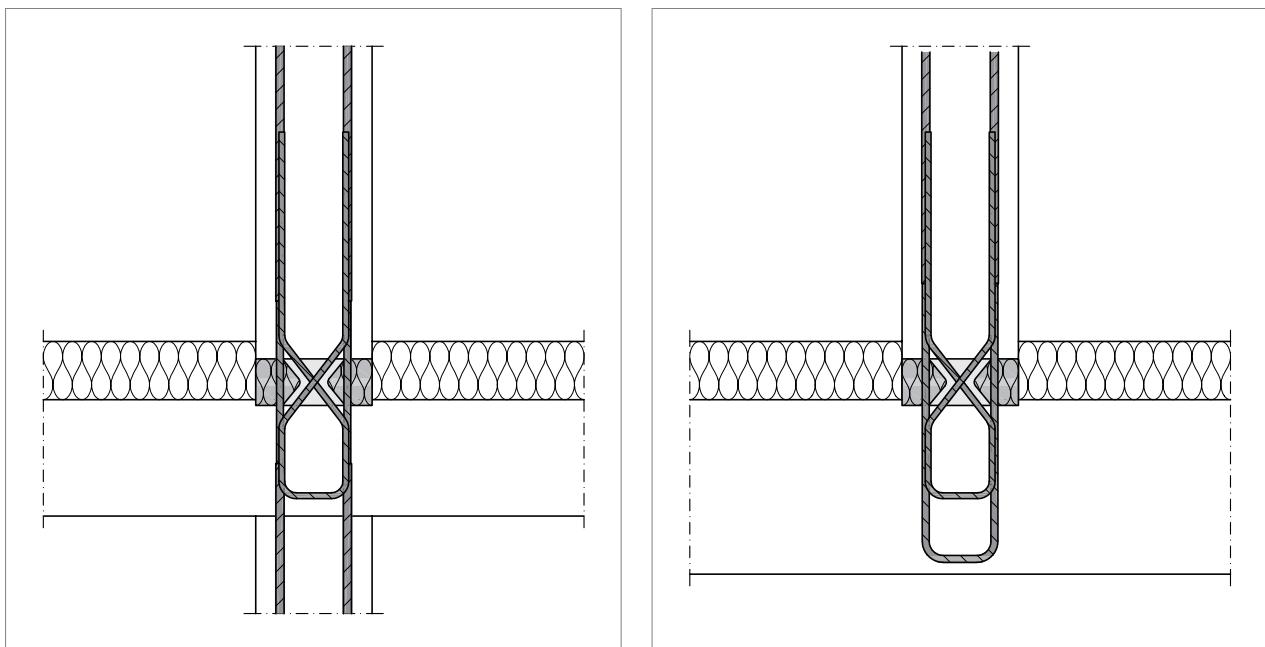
Schöck Sconnex® Typ W Sonderzugelement: Schnitt D-D; Zugkraftverbindung der Wände durch die Decke hindurch
